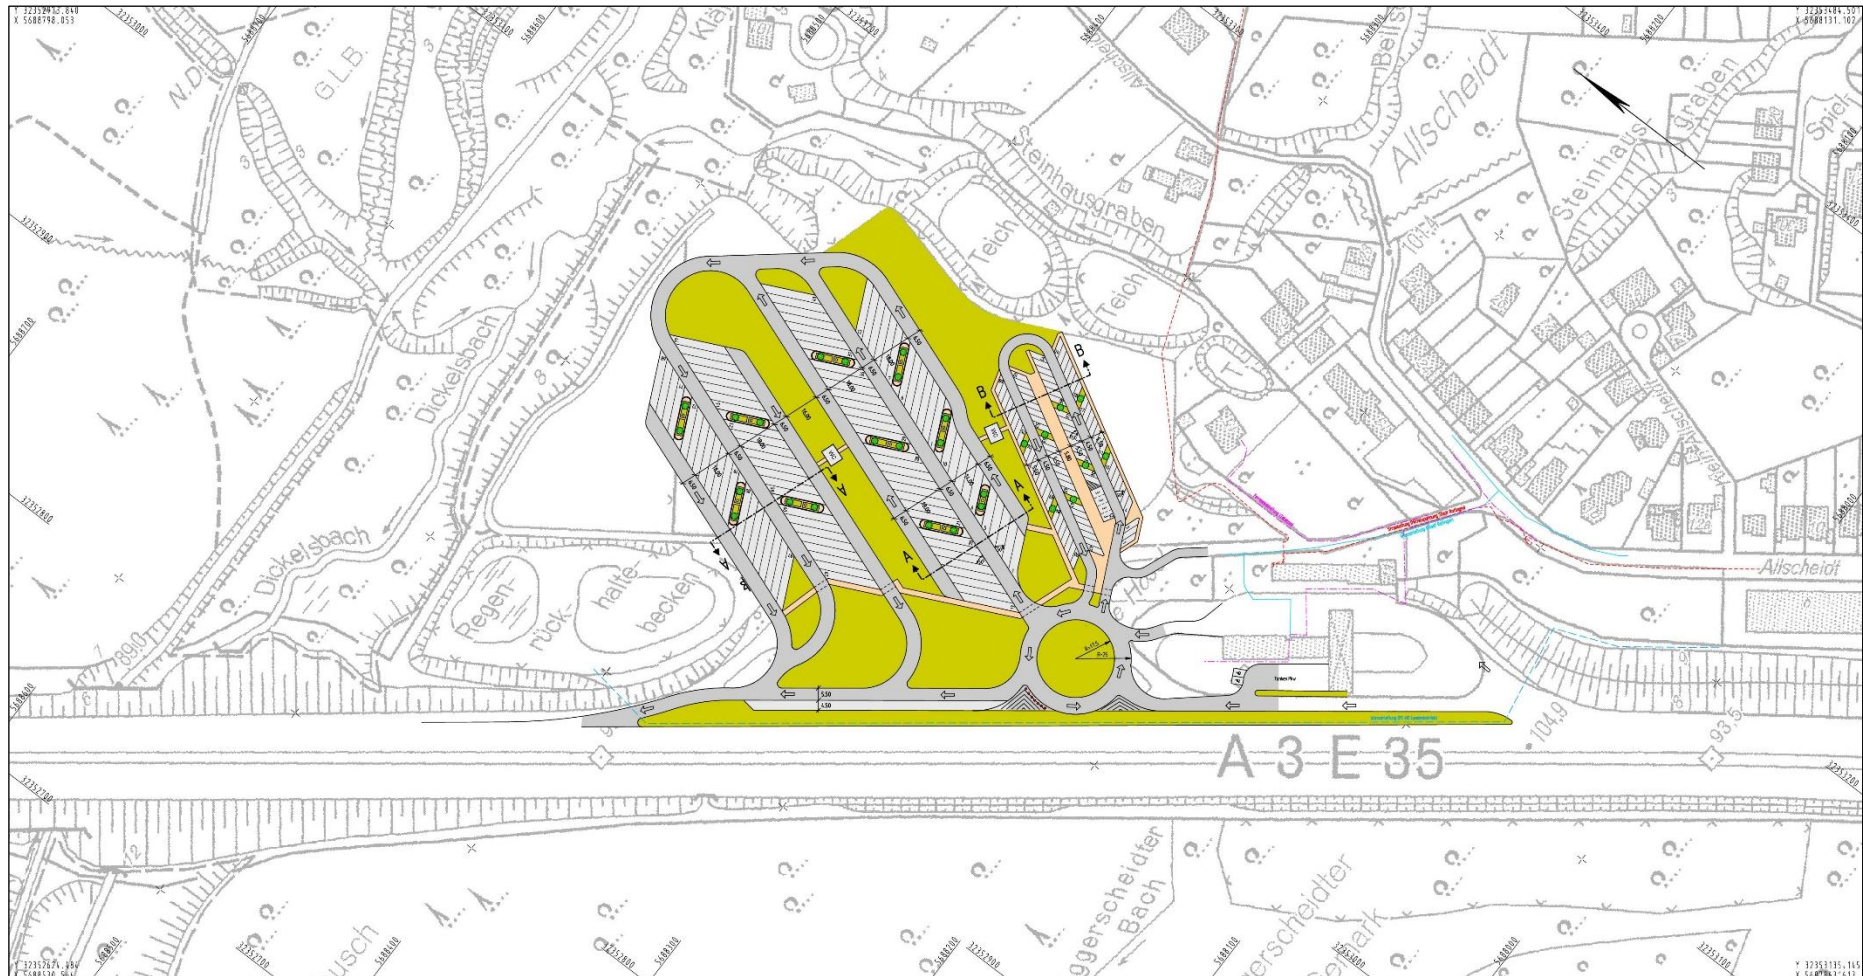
Lageplan der Variante 0 (Quelle: INGENAix GMBH 2018)
